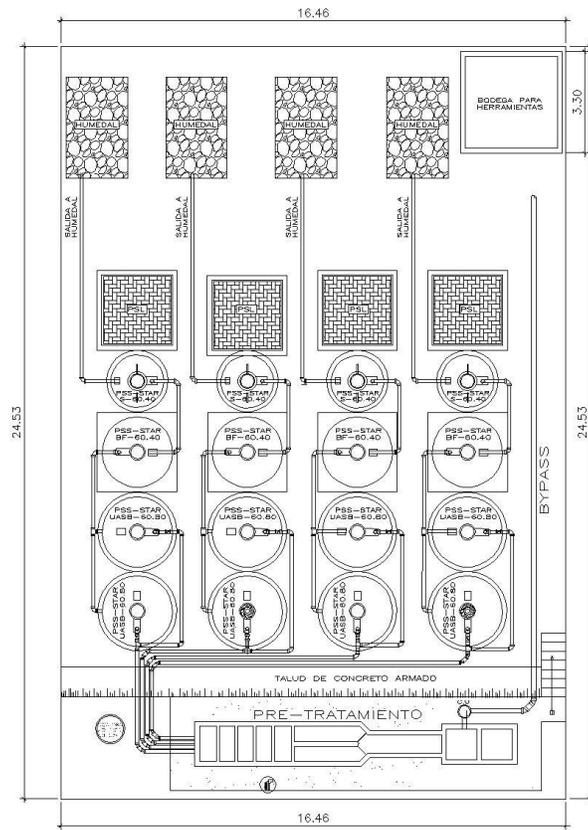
Propuesta de emplazamiento de Planta de Tratamiento. Barrio 1 v 3
